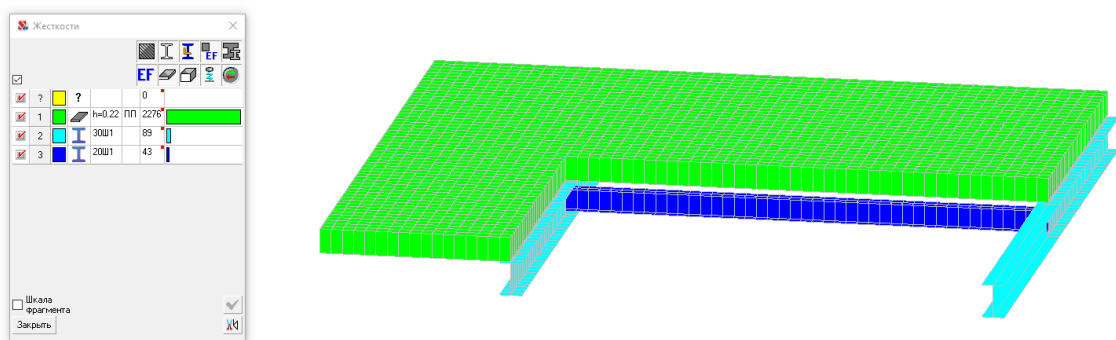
Расчетная схема плиты перекрытия в пространстве
